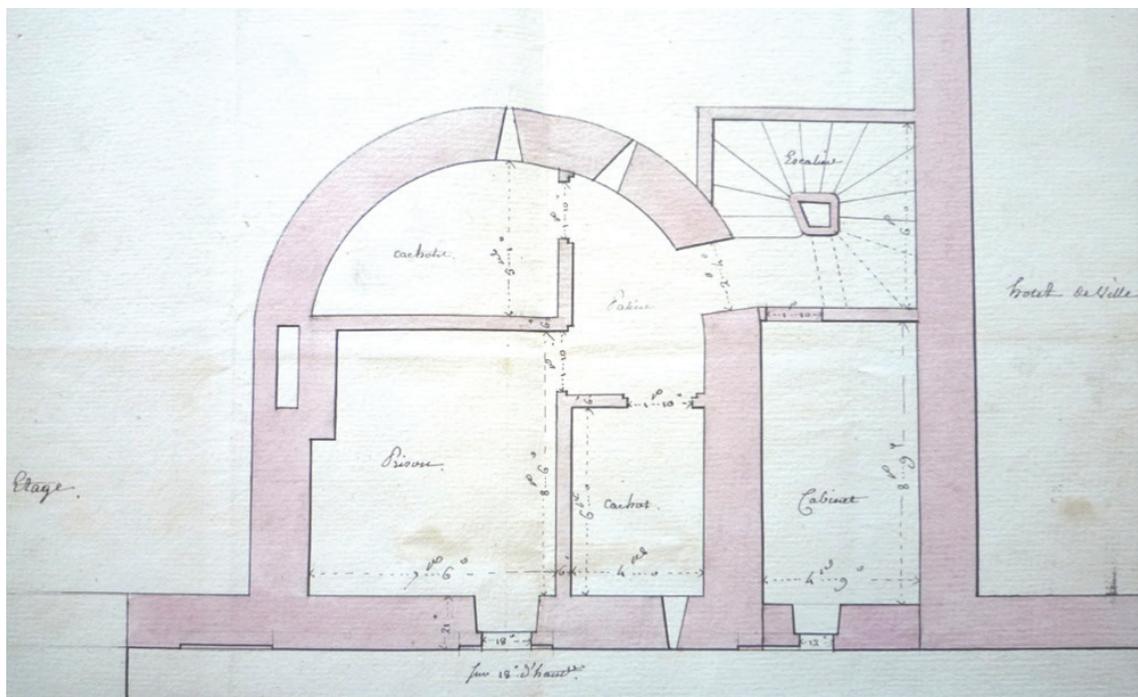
plan de la tour de la prison, XVIII^e siècle.
